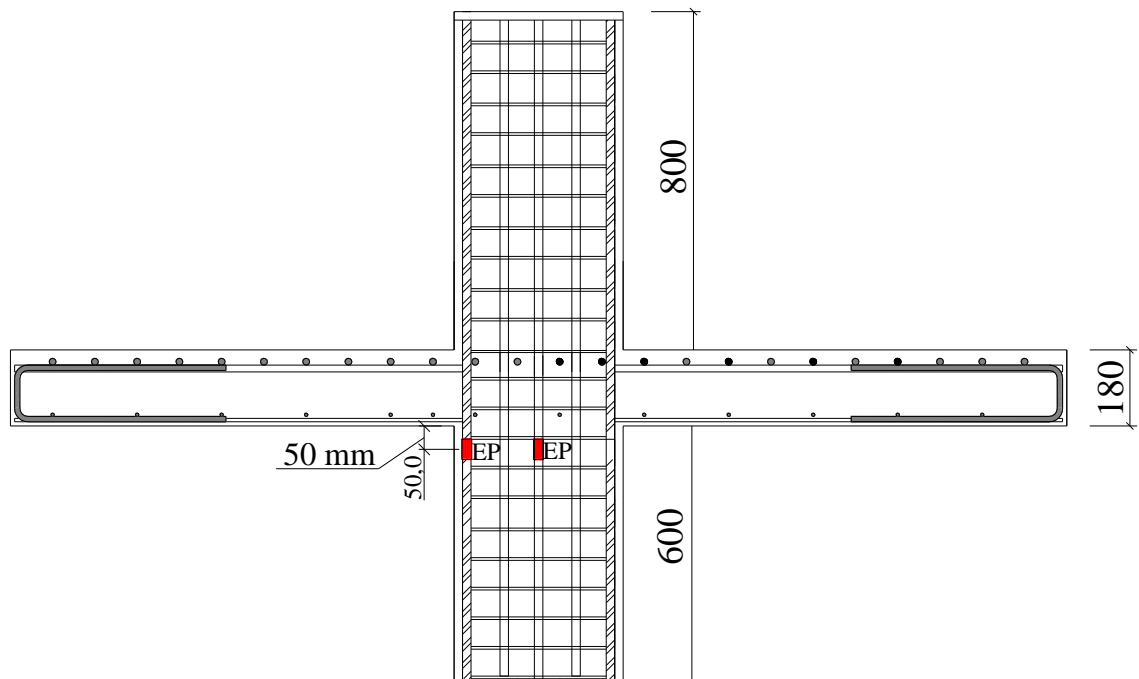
Seção transversal com armadura dos pilares (LW01, LW02 e LW03) e posição dos EER.
